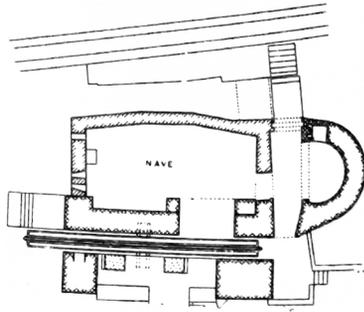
Grundriss, nach Félix Hernández
